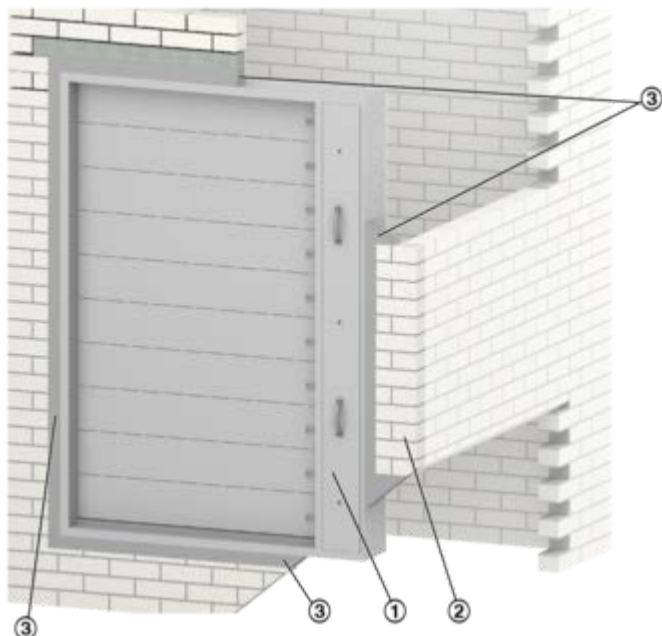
Exemplu de instalare EK-JZ în perete de rezistență plin, tip de instalare pe bază de mortar
